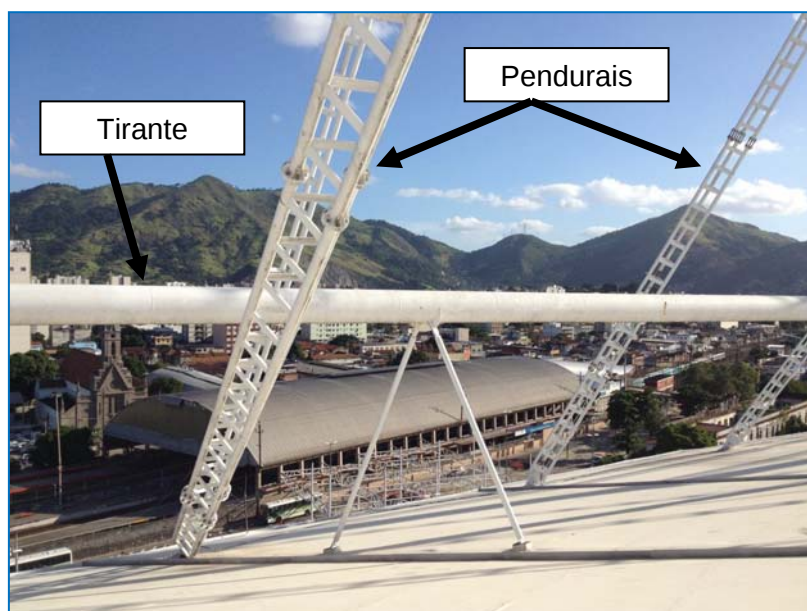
Detalhes da ligação do pendural com a tesoura (que não pode ser vista por estar debaixo do telhado), do tirante do arco (elemento tubular horizontal que liga as extremidades do arco), bem como os apoios do tirante sobre as tesouras (pórticos planos), cuja finalidade é apenas manter o tirante reto
